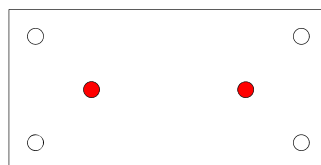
Plan de chevillage complémentaire (après marouflage de l'armature) pour finition par plaquettes de parement en terre cuite
